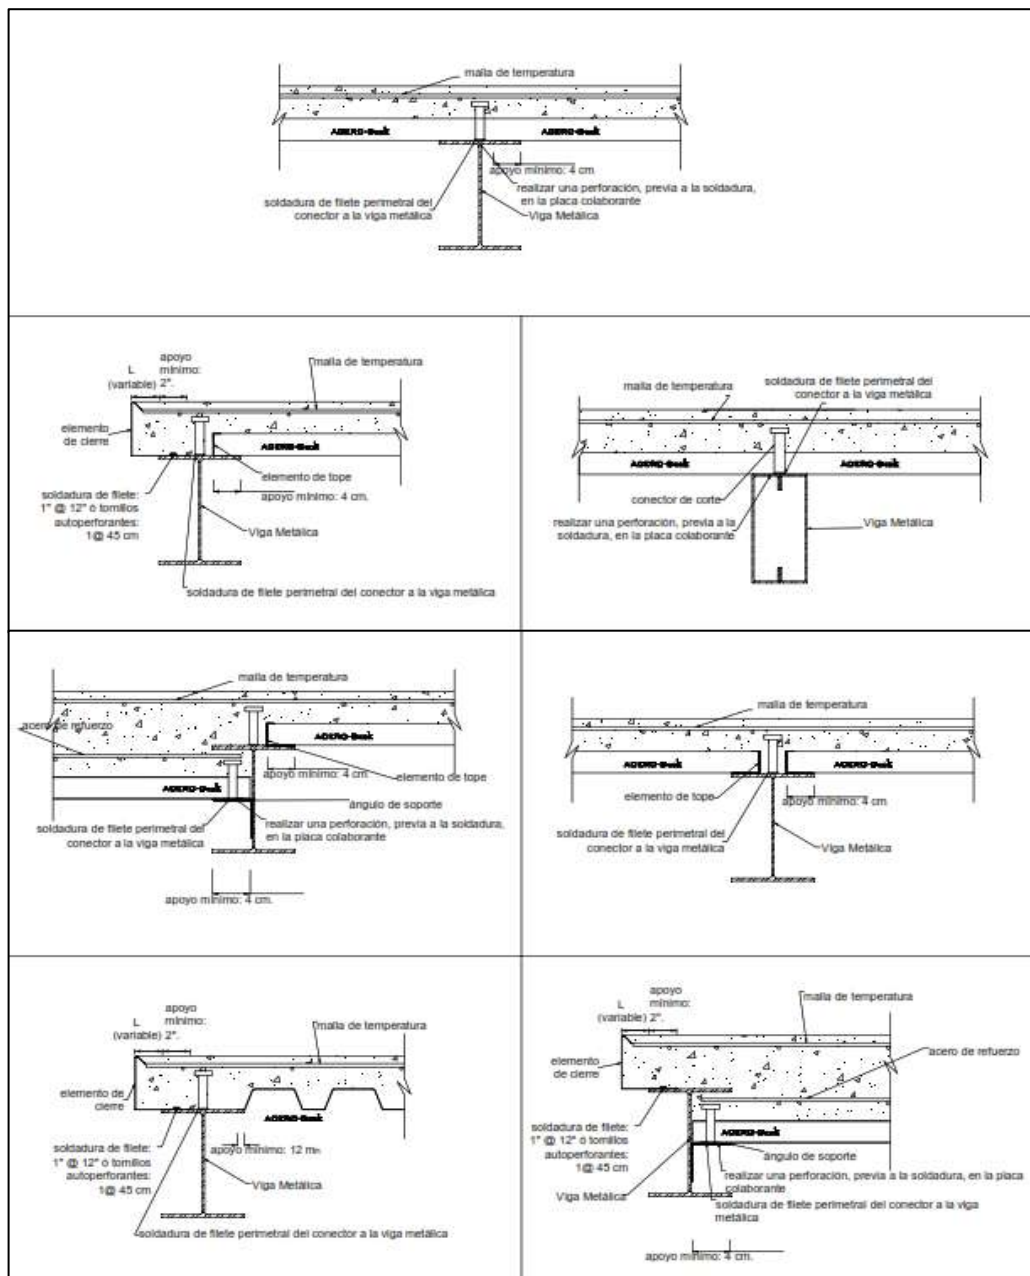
Detalle constructivo de apoyos sobre vigas metálicas [1][8]
